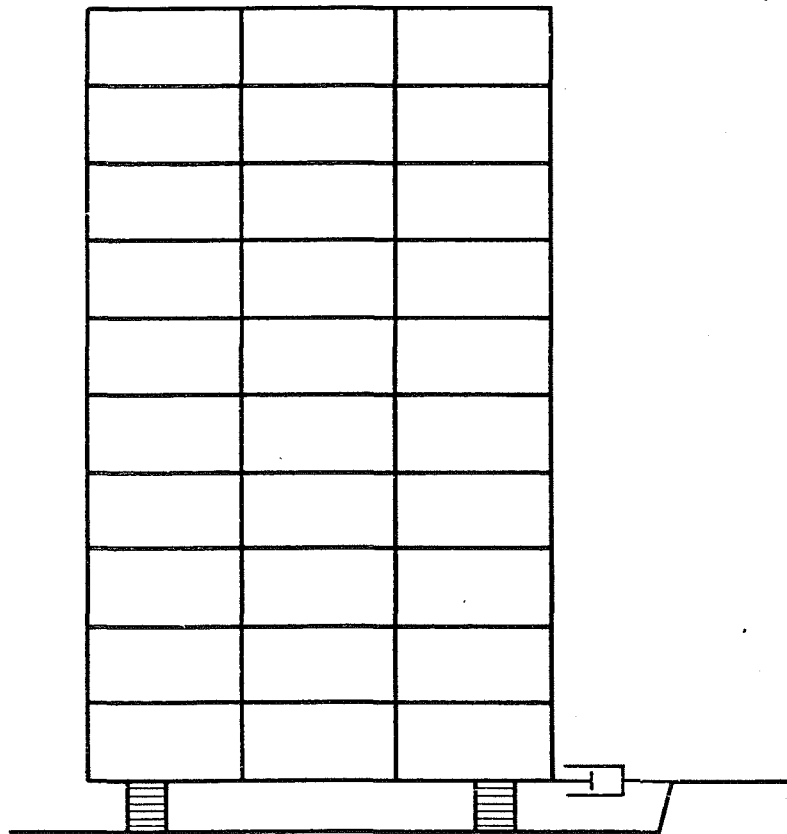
Edificio con sistema de aislamiento de base.
